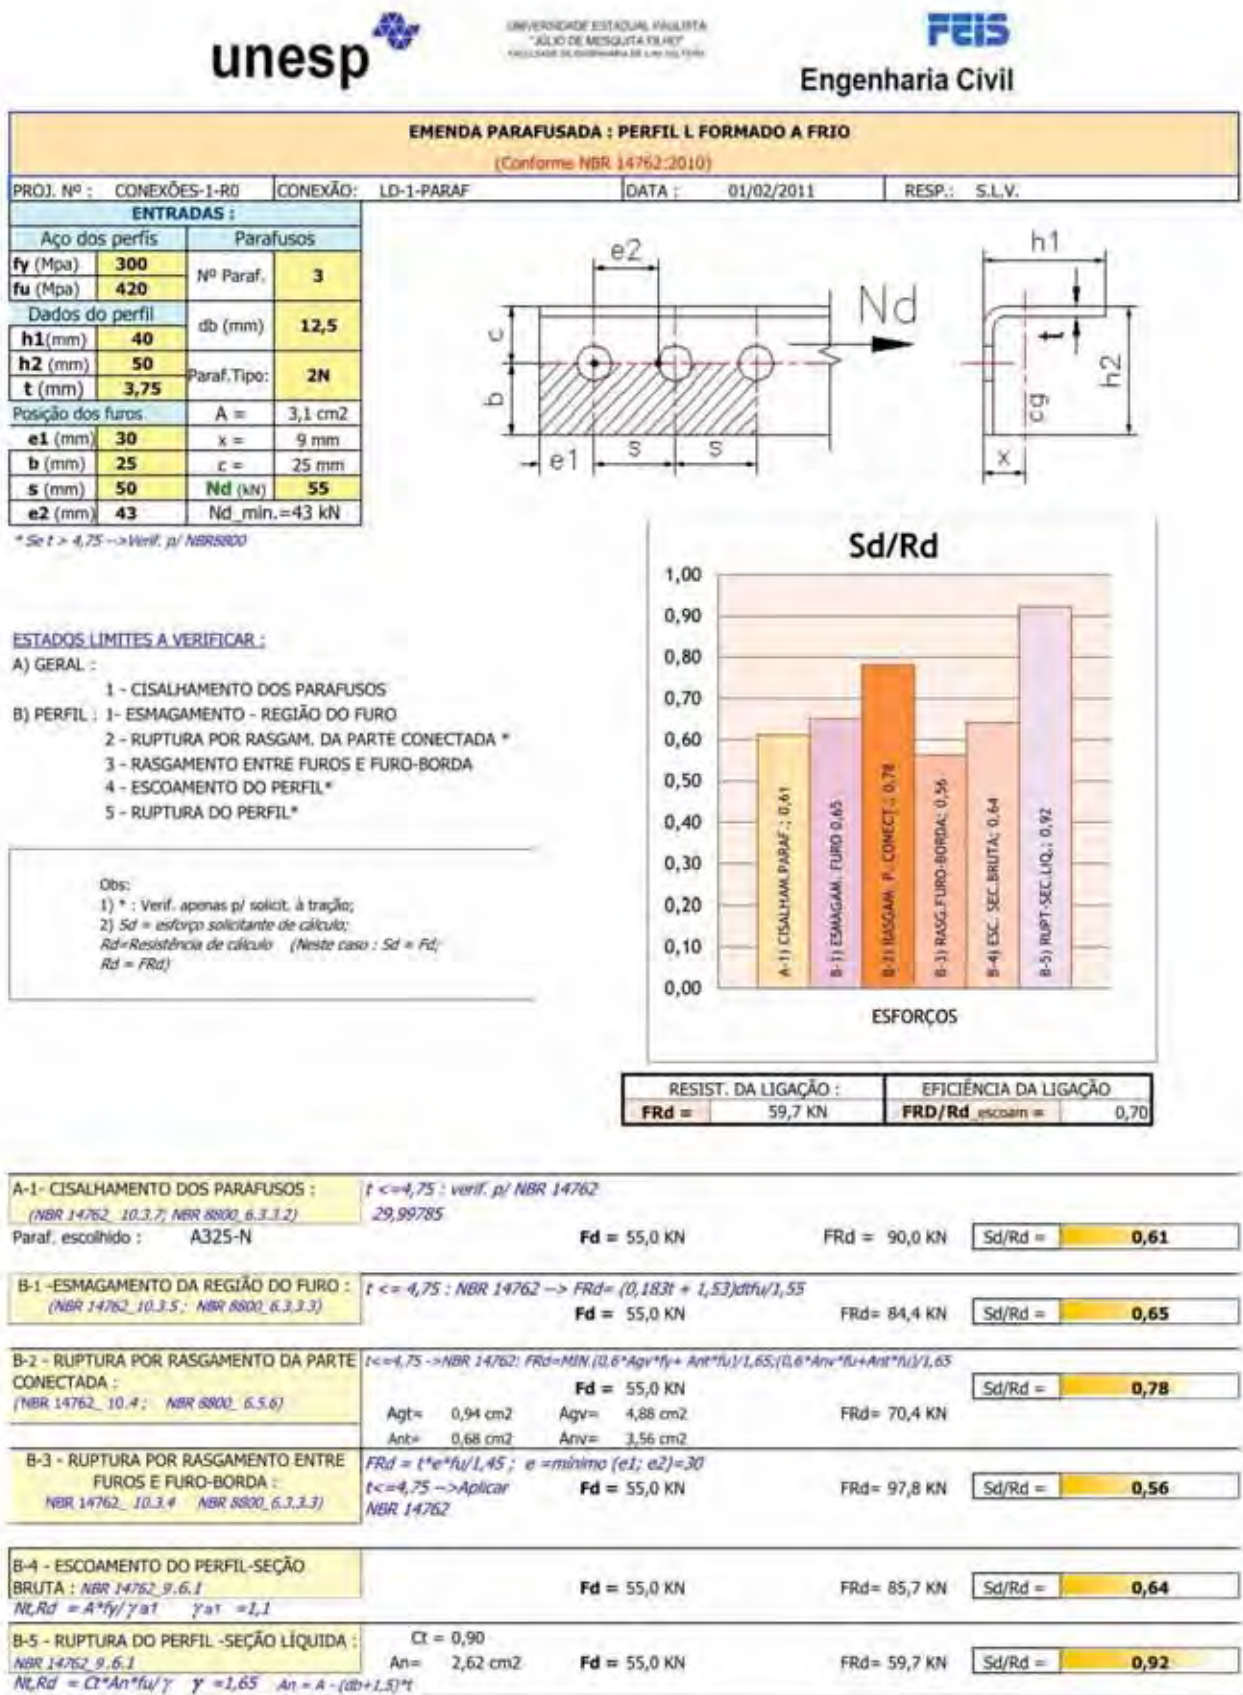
Reprodução da aba “Notas” da planilha de dimensionamento de ligações parafusadas de perfil “L” formado a frio
